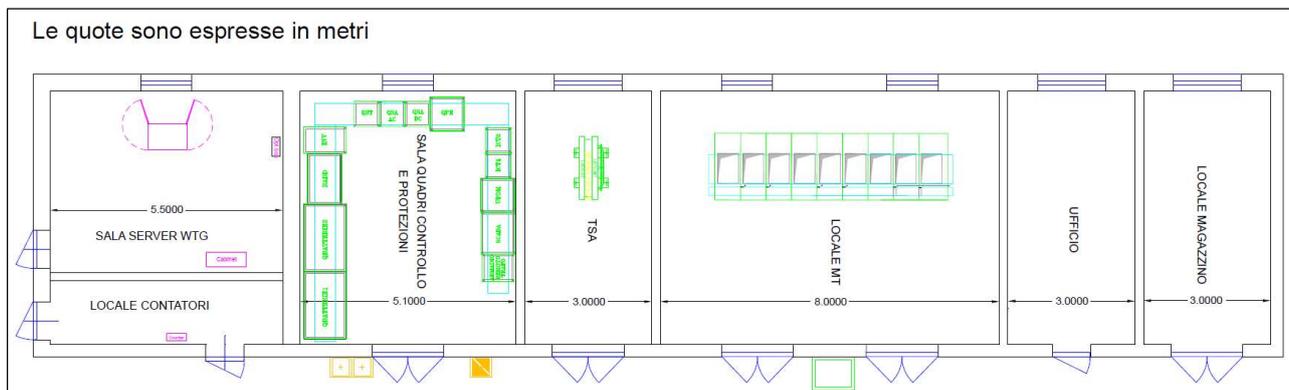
Pianta edificio di controllo SEU 150/30 kV
